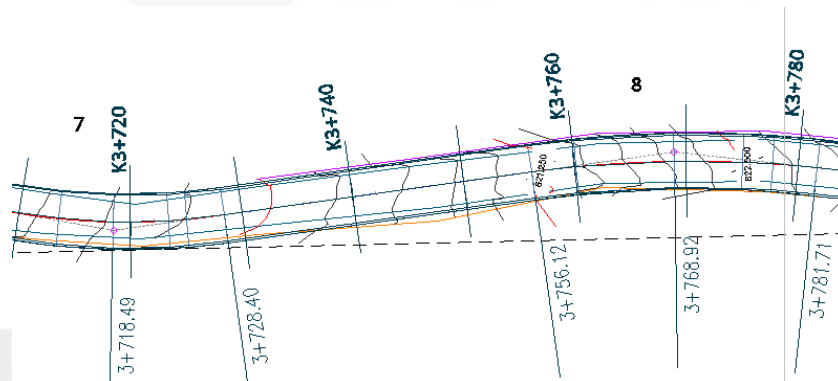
PLANTA ZONA DE INTERVENCION
